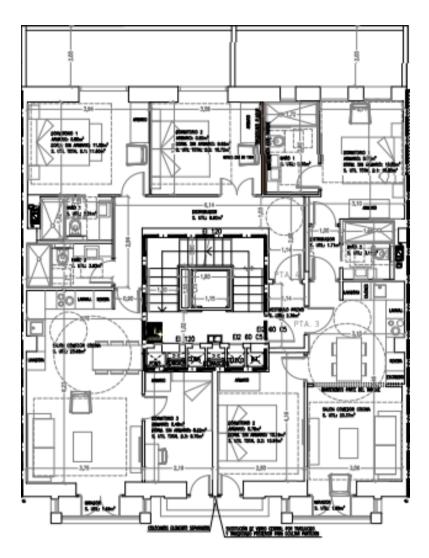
Estado reformado planta 2. Fuente: Creación Propia
